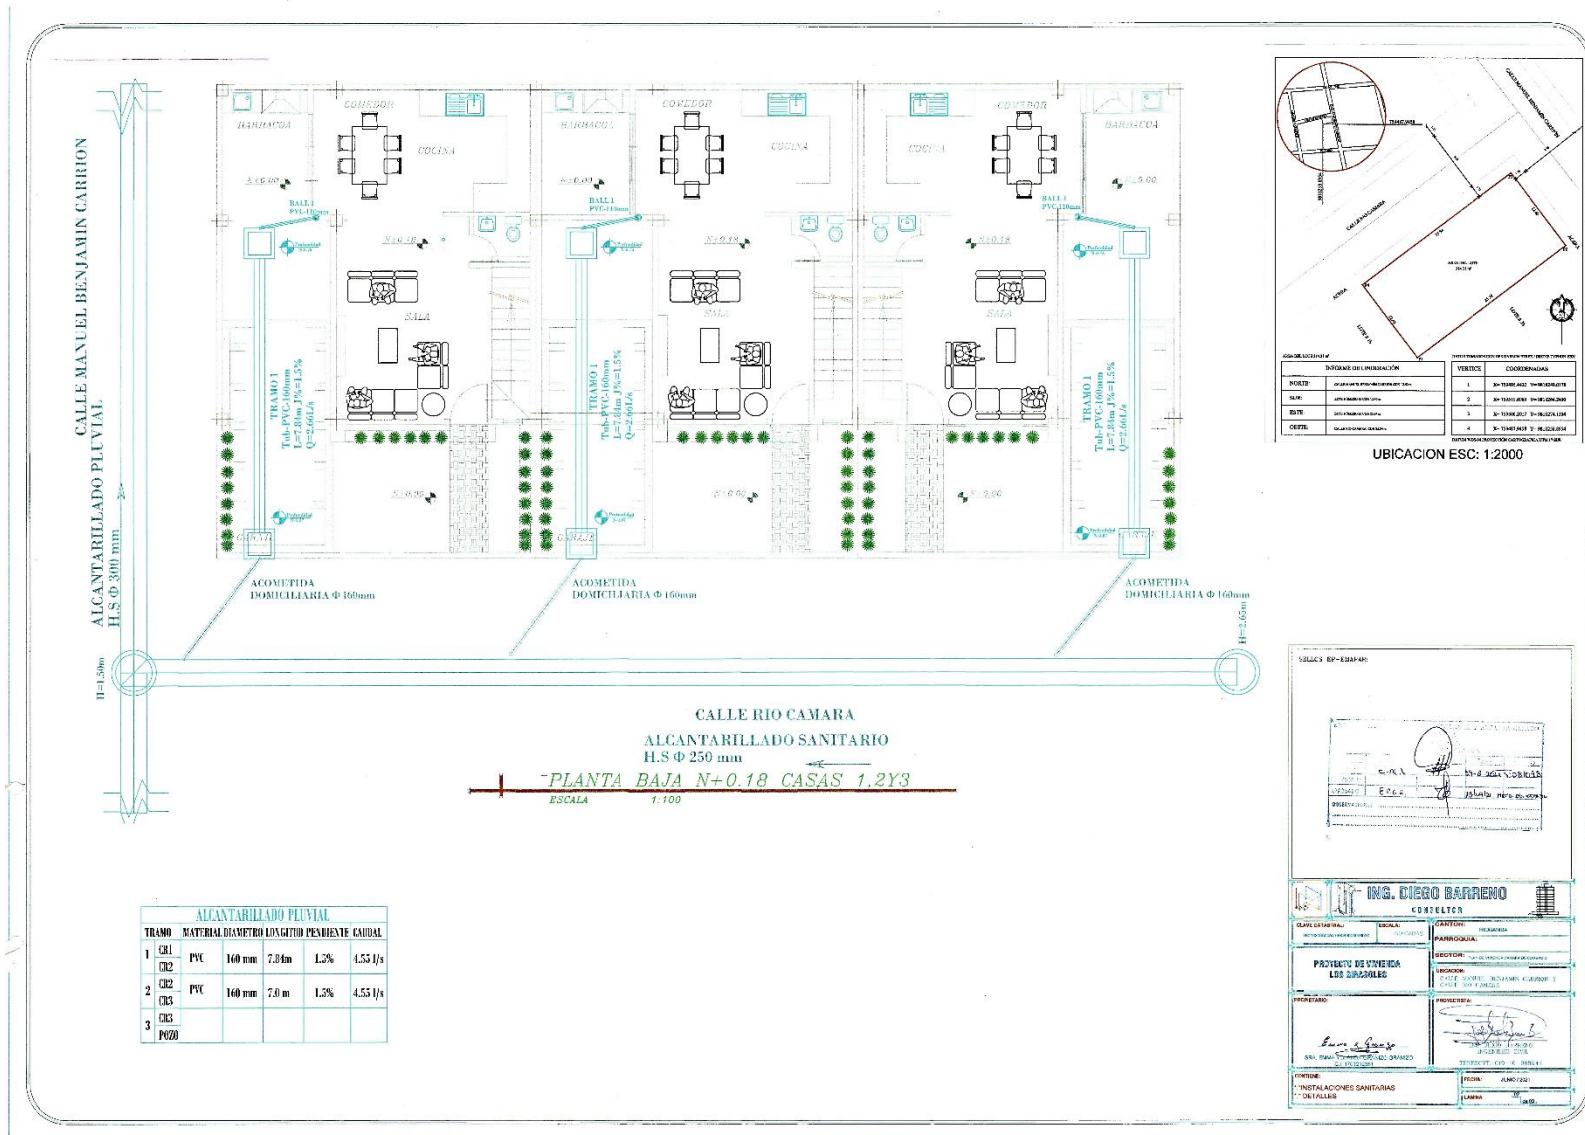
Plano instalaciones hidrosanitaria alcantarillado Pluvial
